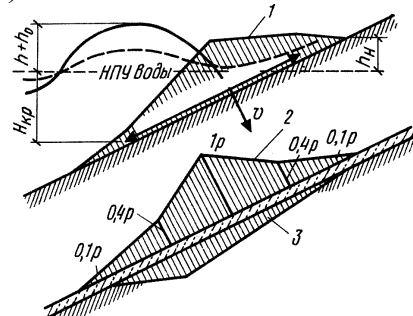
Эпюры волнового воздействия на железобетонное крепление верхового откоса земляной плотины:
